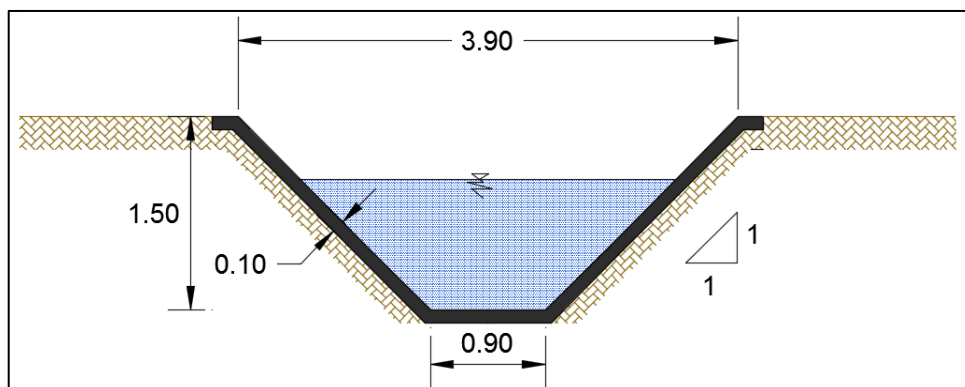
Sección típica del canal Integrador Santa San Bartolo
